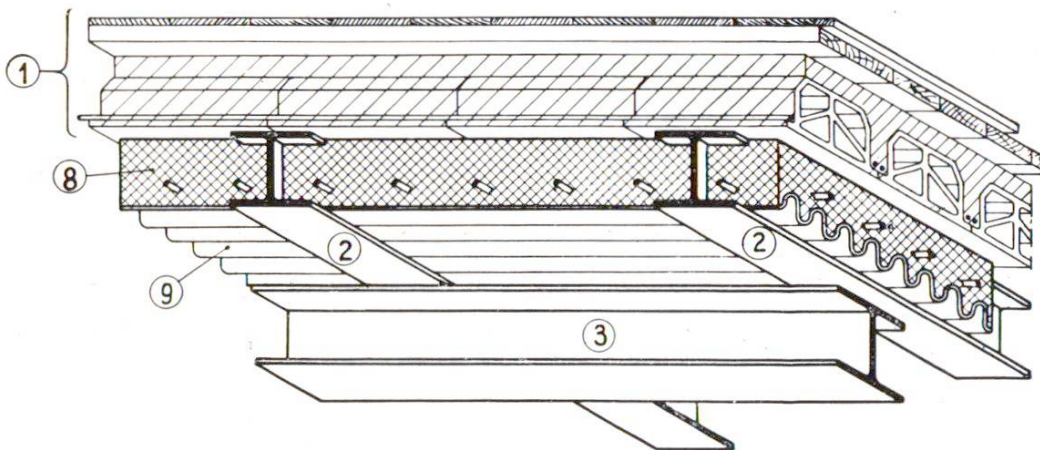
Bau eines Luftschutzraumes aus Eisenbeton.
